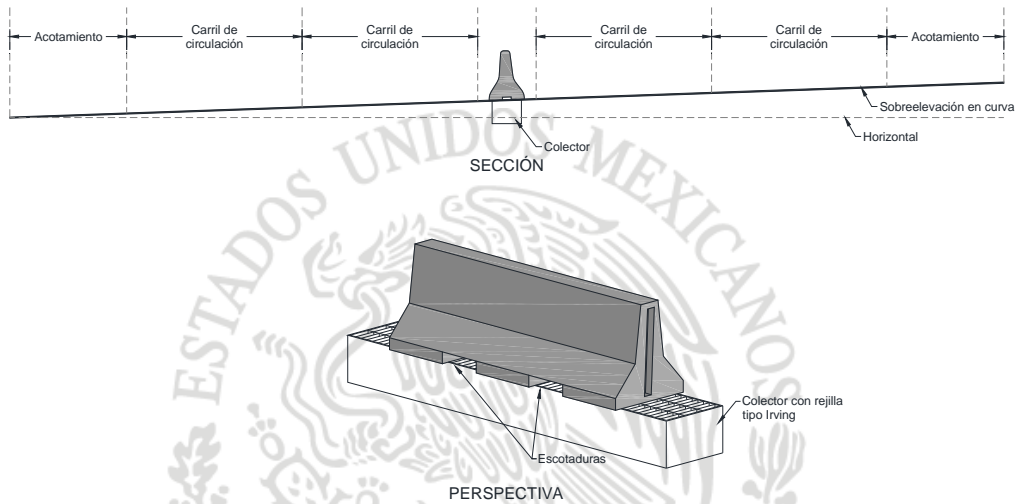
Dren interceptor debajo de barrera central con escotaduras
